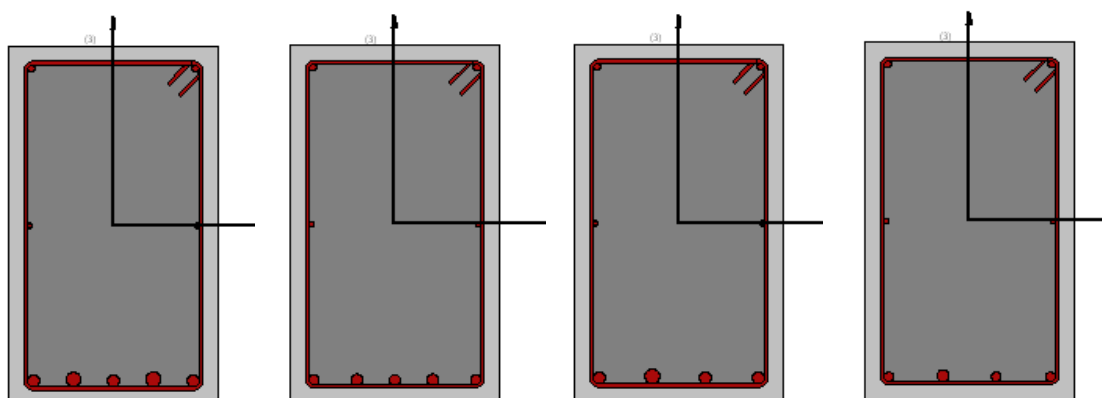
Secções transversais a meio vão das vigas V11, V12, V21 e V22, respetivamente.
